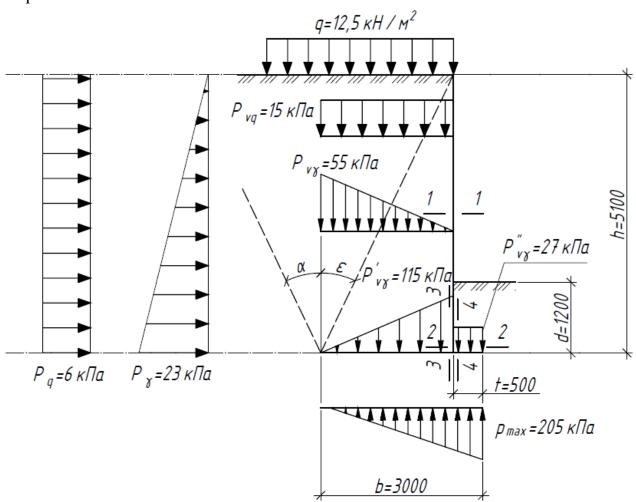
Расчётная схема и схема приложения нагрузок к подпорной стене.
